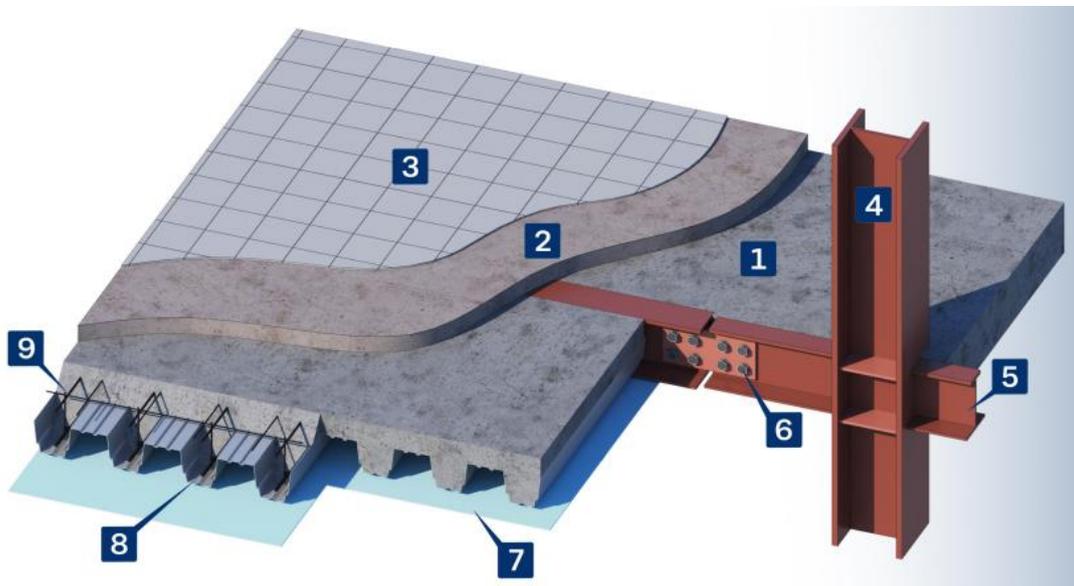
Композитное перекрытие в здании на стальном каркасе: 1 – монолитная плита по профилированному настилу; 2 – стяжка пола; 3 – пол; 4 – колонна; 5 – балка; 6 – узел на болтах; 7 – натяжной потолок; 8 – профилированный лист; 9 – армирование
